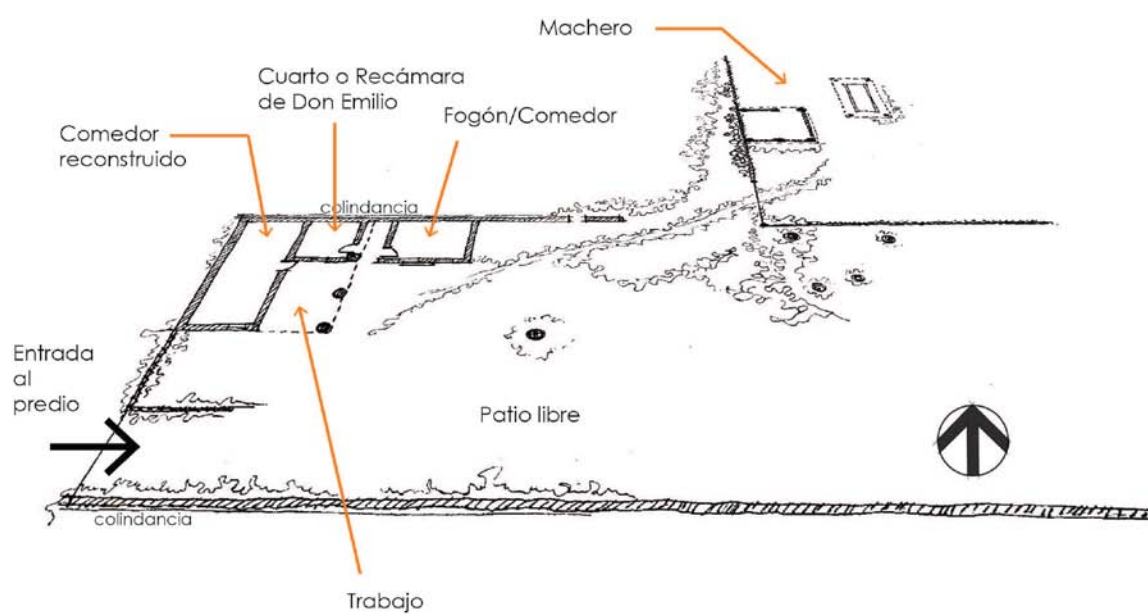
Planta Arquitectónica de la configuración espacial en la vivienda de Don Emilio.
